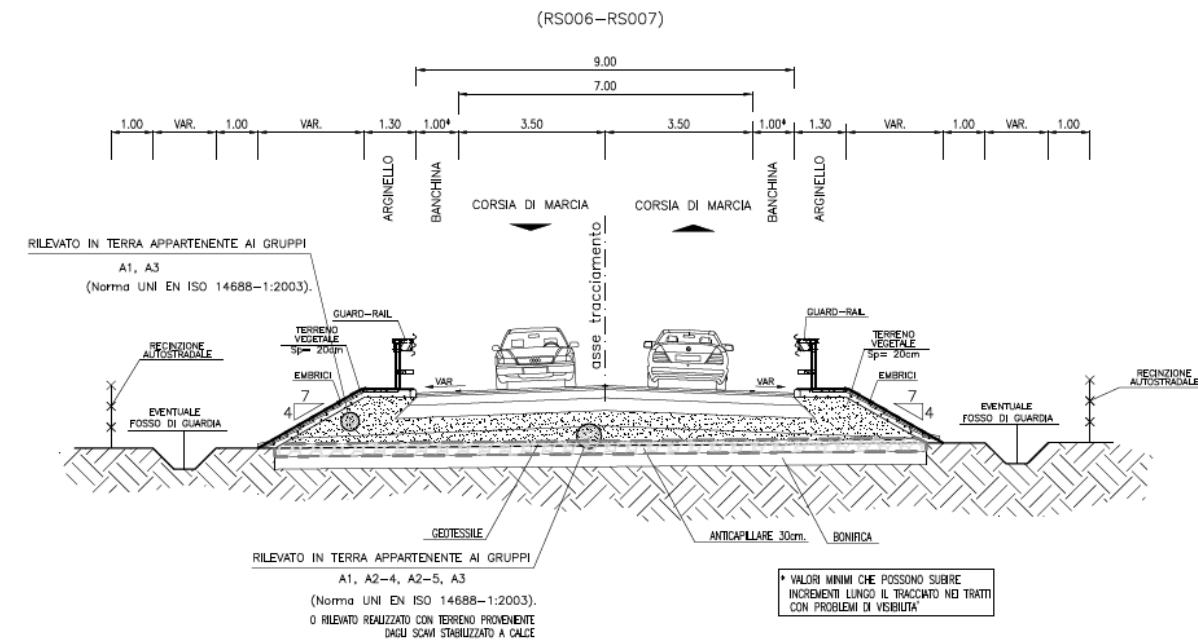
Sezione tipo rampa bidirezionale RS006-RS007
